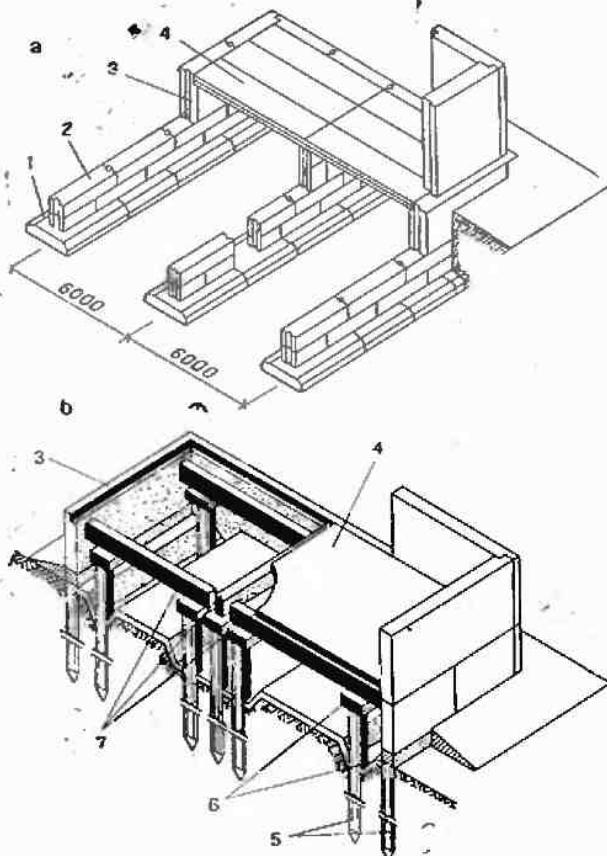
Подземная часть бескаркасных крупнопанельных зданий
